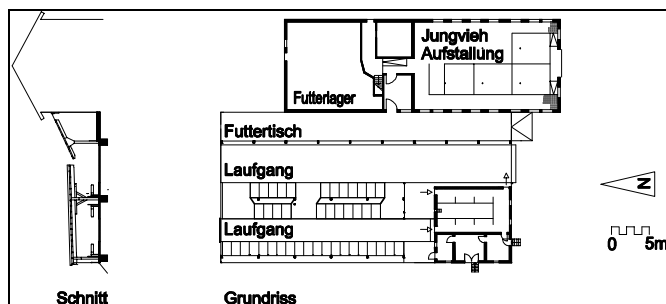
Grundriss und Schnitt des Betriebes Haneberg, Kempten.
